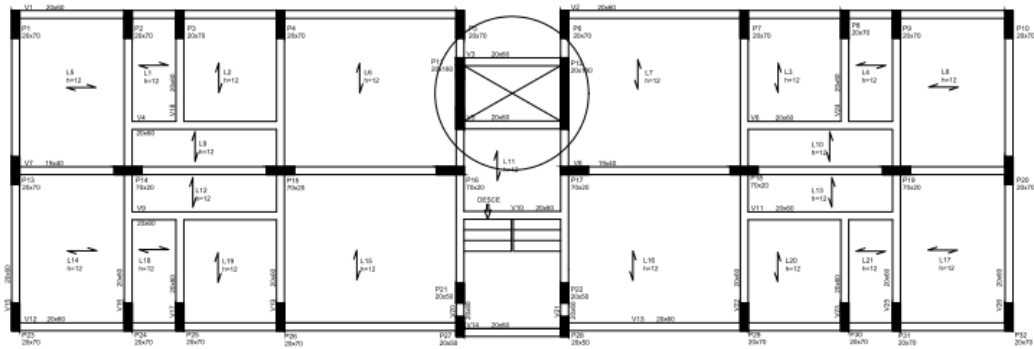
Planta tipo Caso 3 – pilares-parede na região do elevador
